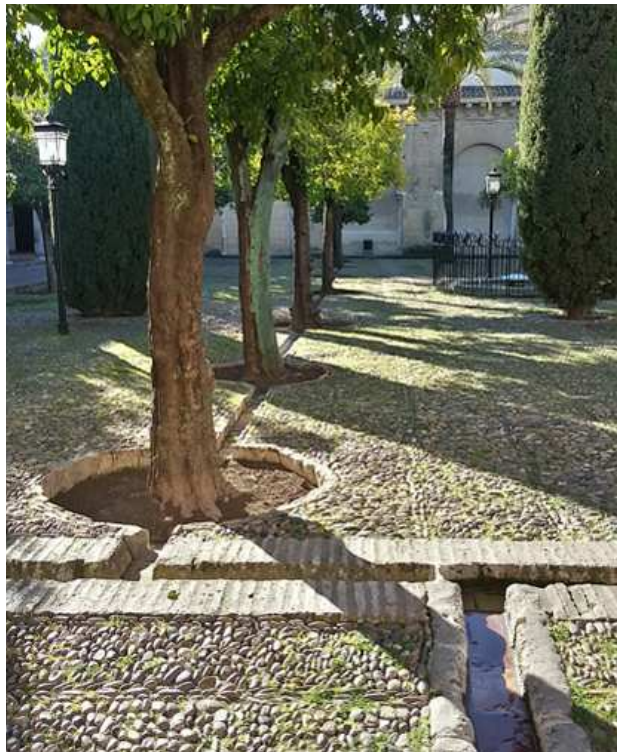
Pavimento de chino cordobés en el Patio.
